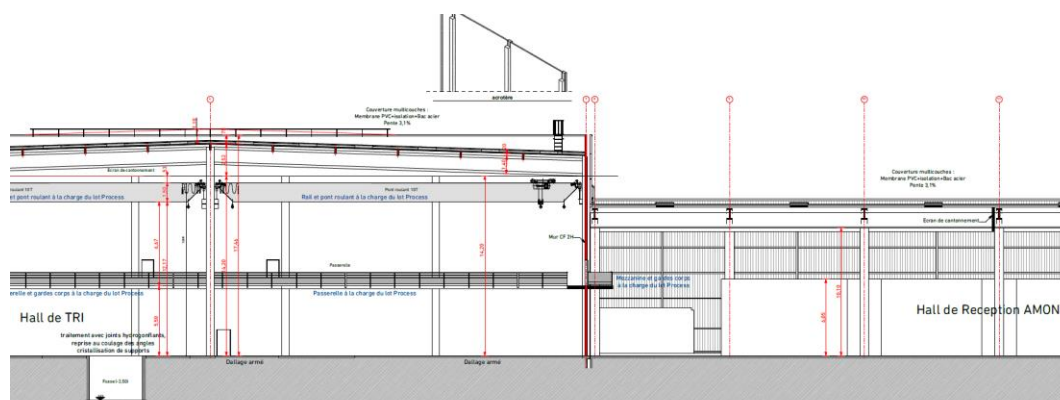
Vue en coupe séparation du hall amont et hall de tri séparés par un mur REI 120 coupe-feu 2H en dépassement en toiture (source : Trinovia)
